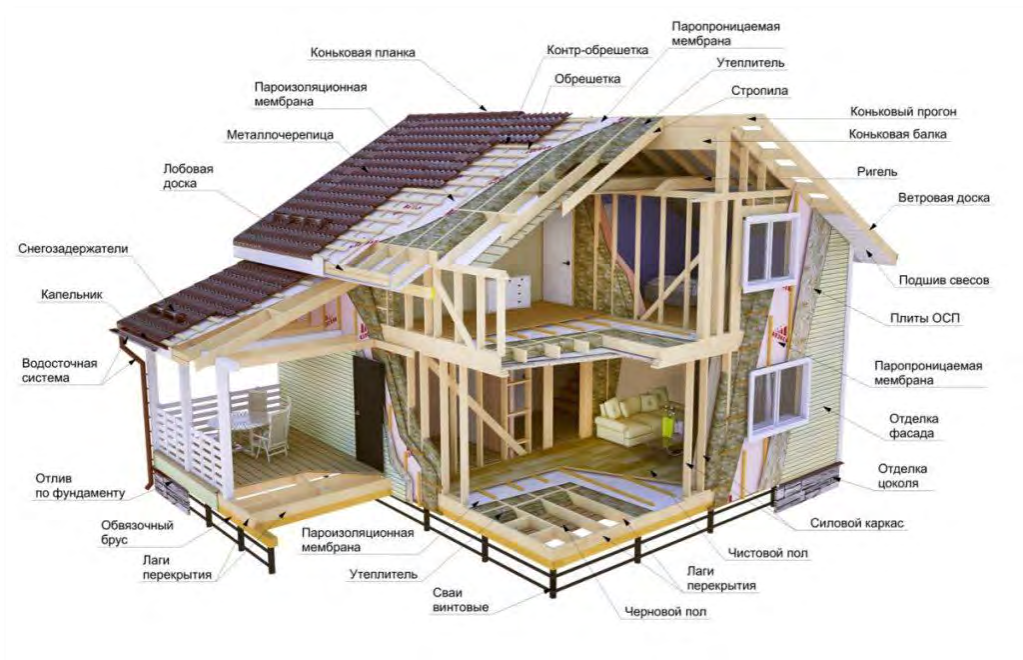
Схема збору будівлі з дерев'яним каркасом
